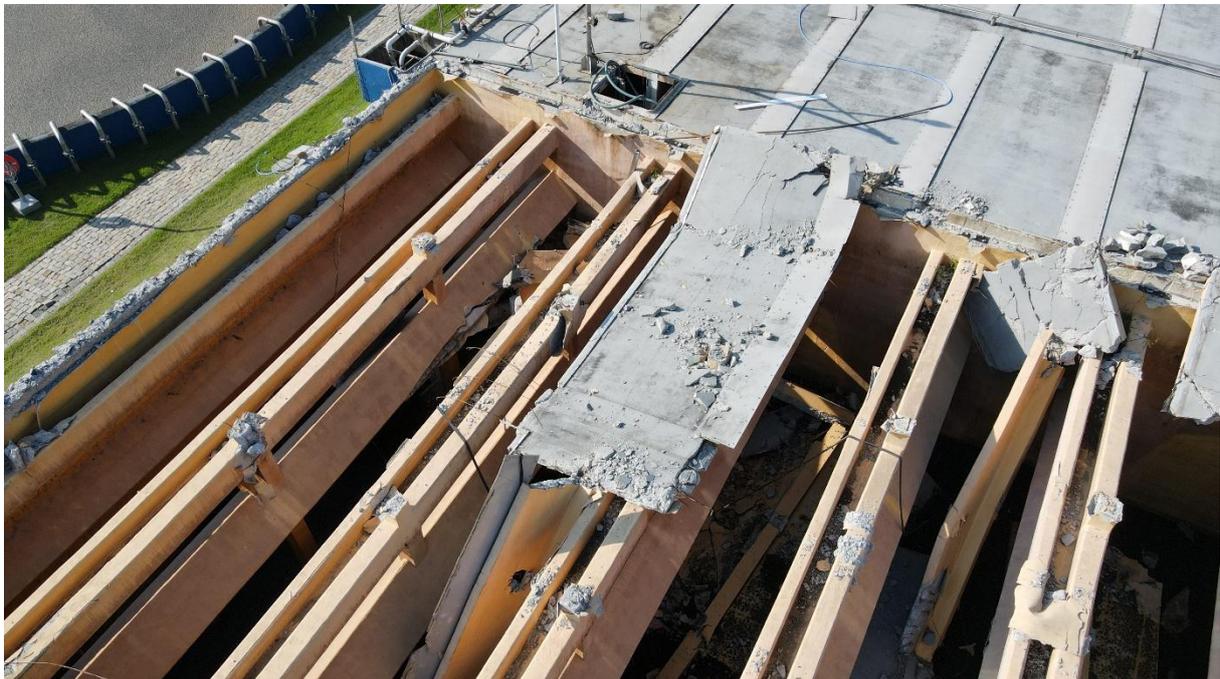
Parte da laje ainda apoiada nas vigas de sustentação.
